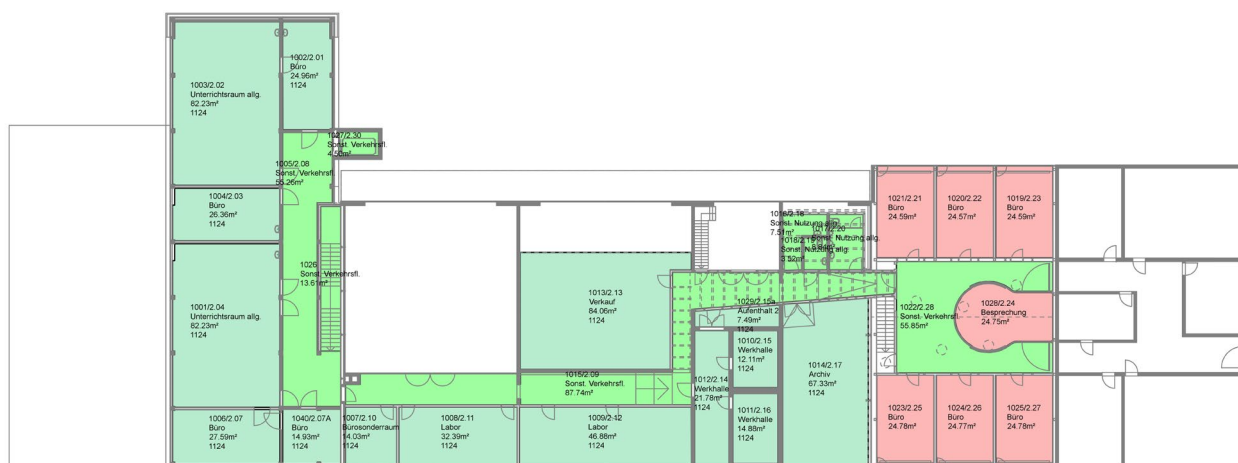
Grundriss Vauffelin 1.OG (grün BFH - rot DTC)
